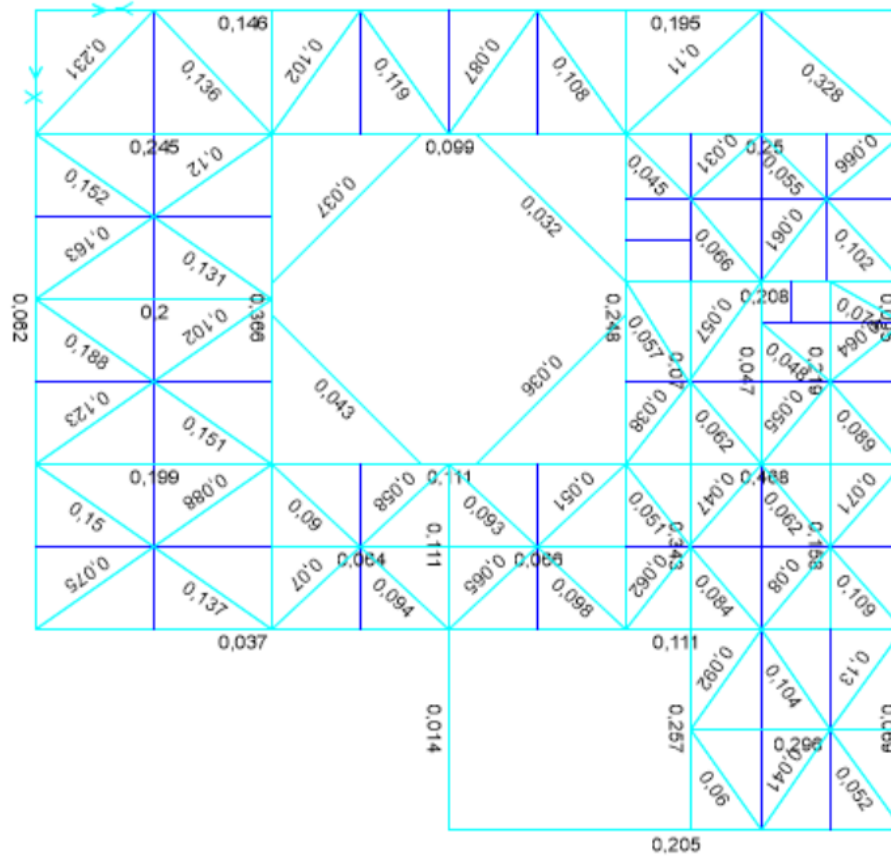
Factores de utilización vista en elevación 5.88 [m] sobre nivel de terreno.
